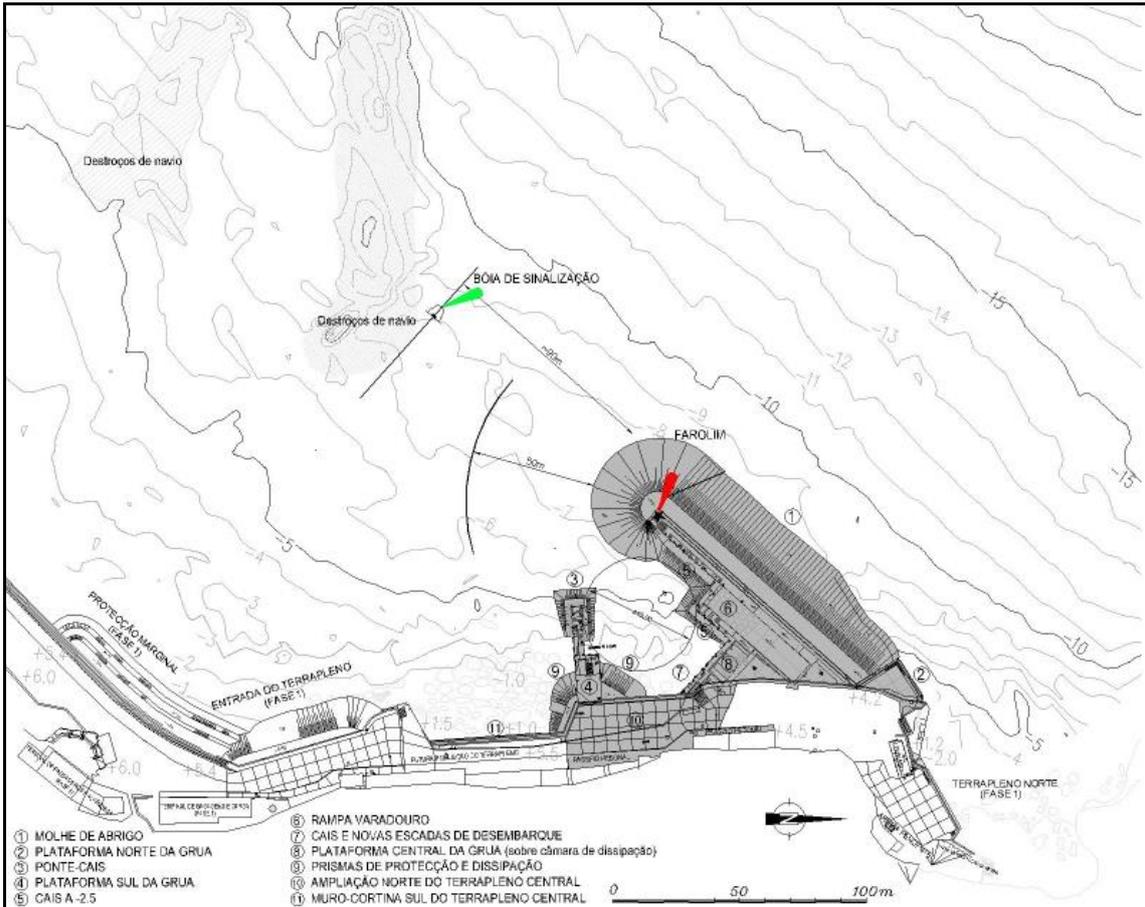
Planta de arranjo geral da Fase 2 (revisão/alteração)
